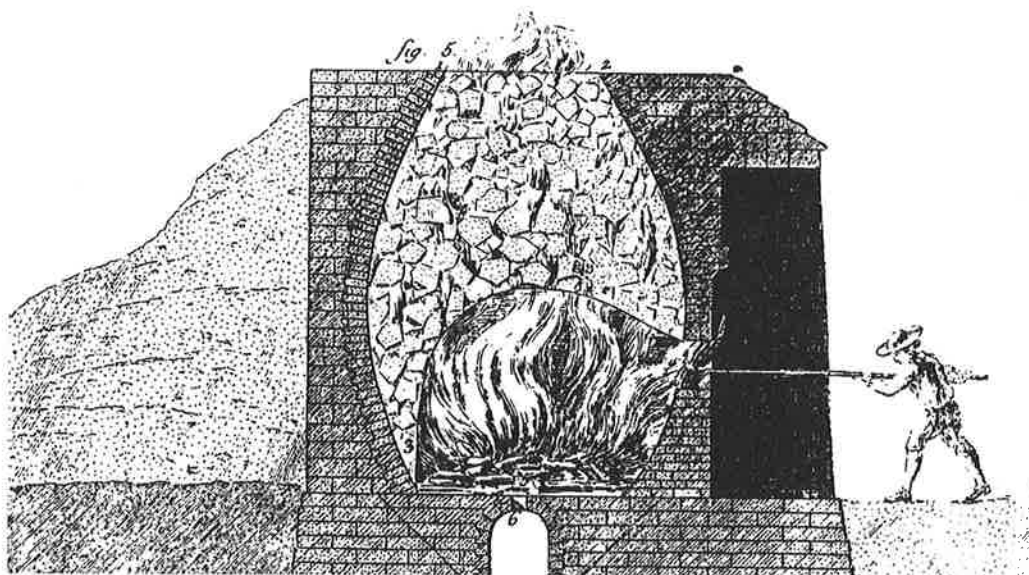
『百科全書』図版 (Planche) による「石灰釜」(Chaux à four) 断面図
